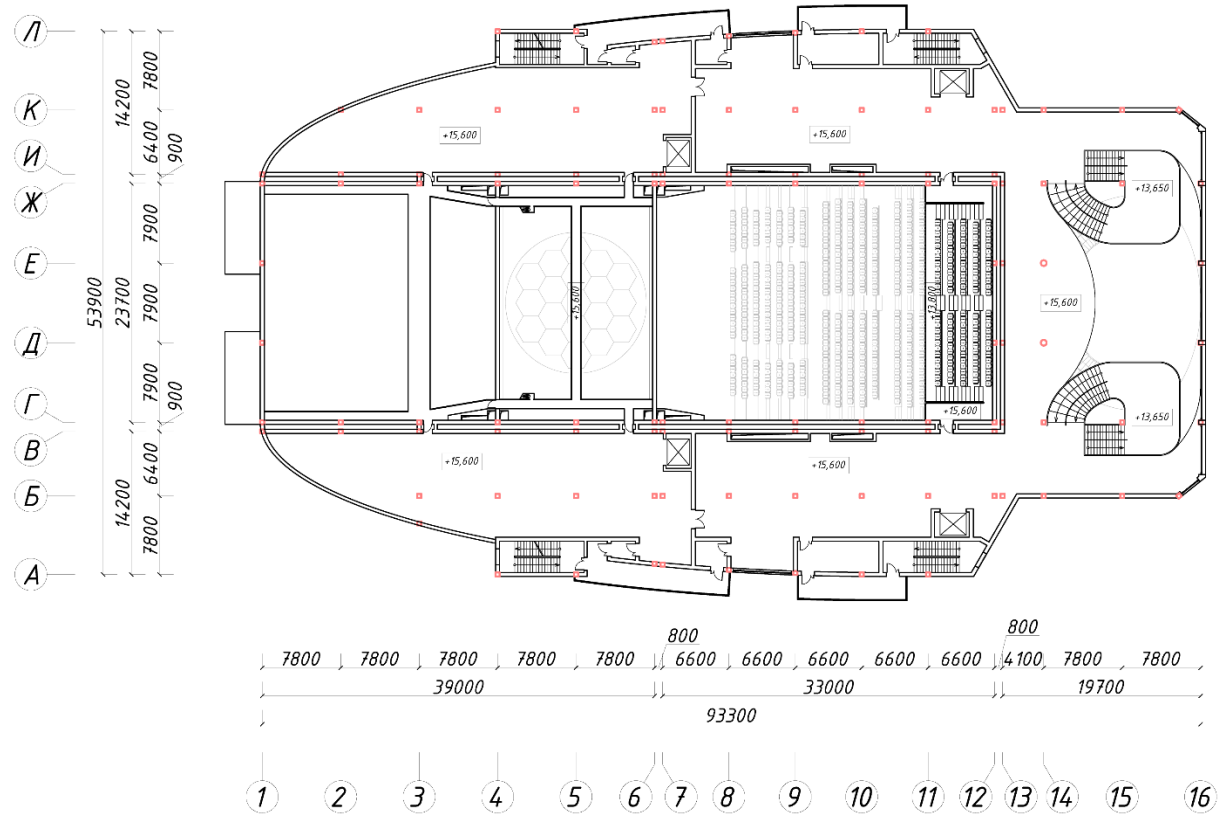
Схема плану поверху на позначці +15.600.
